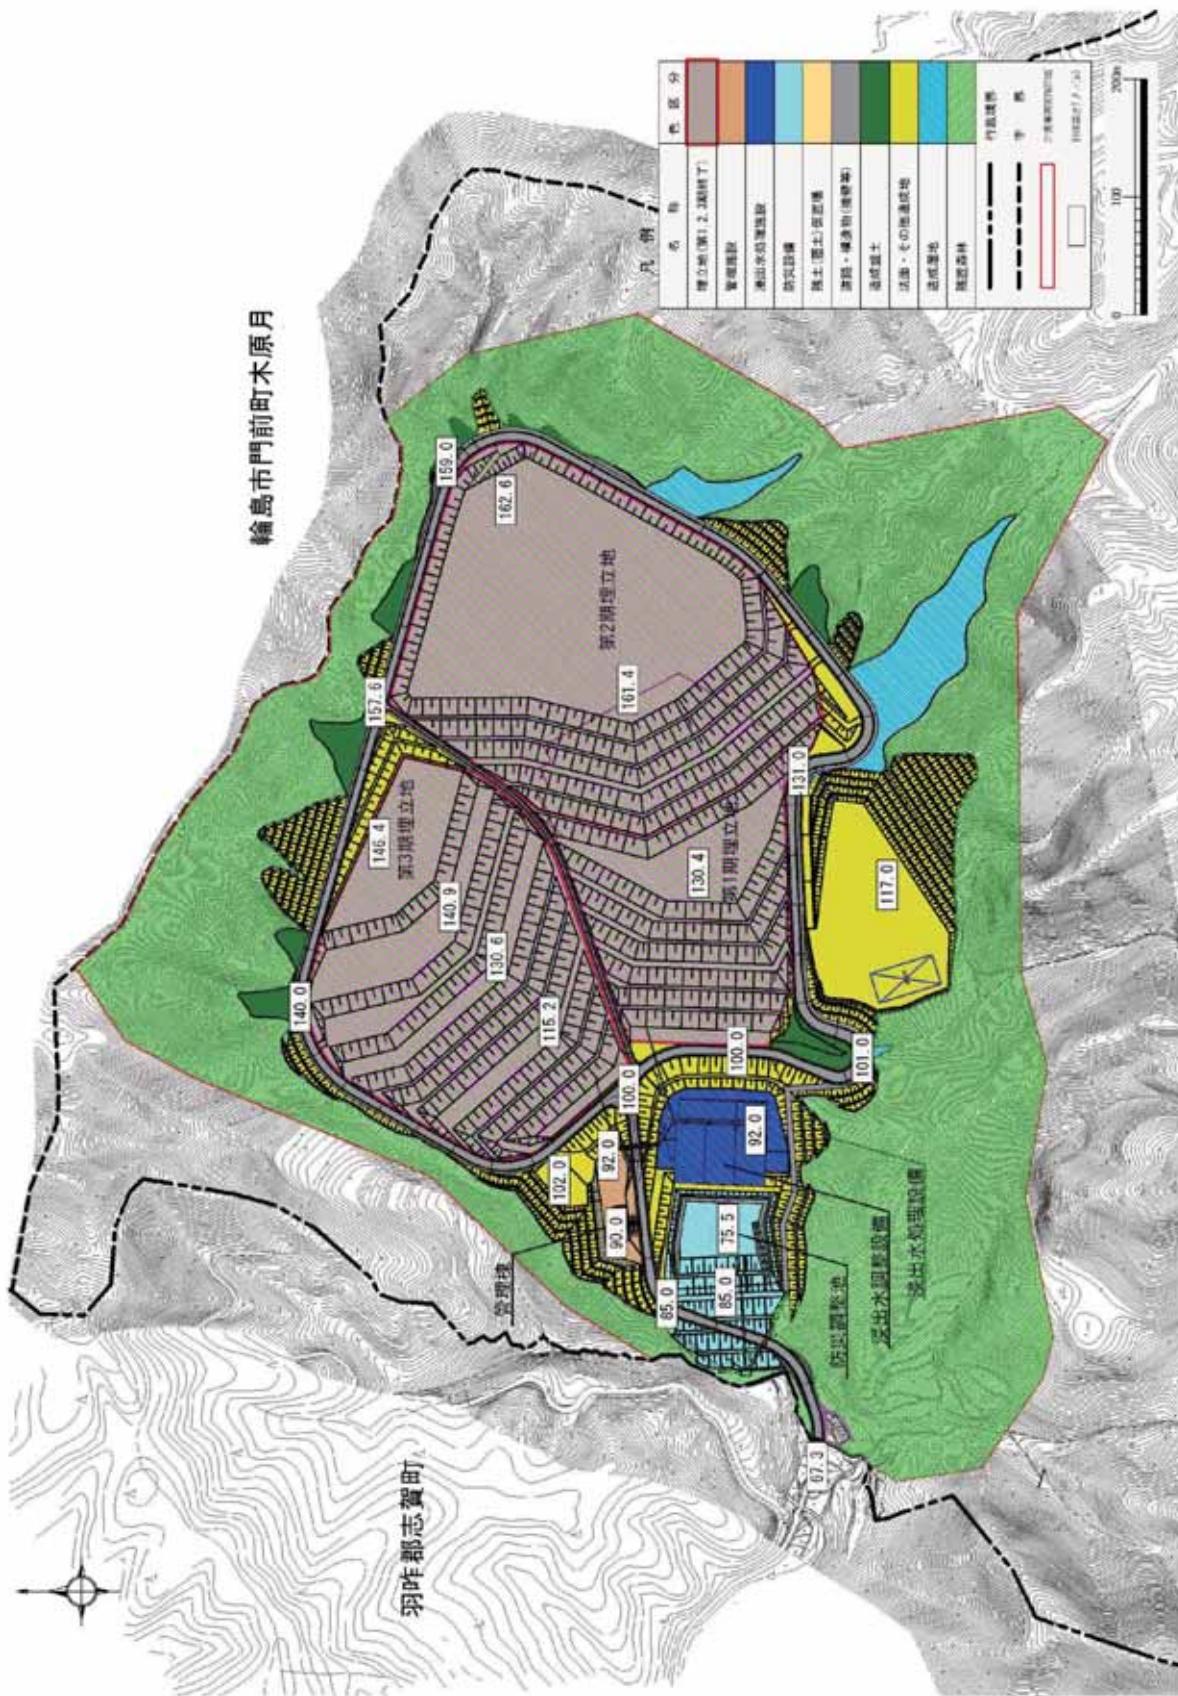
造成・施設配置計画平面図（埋立終了時）
